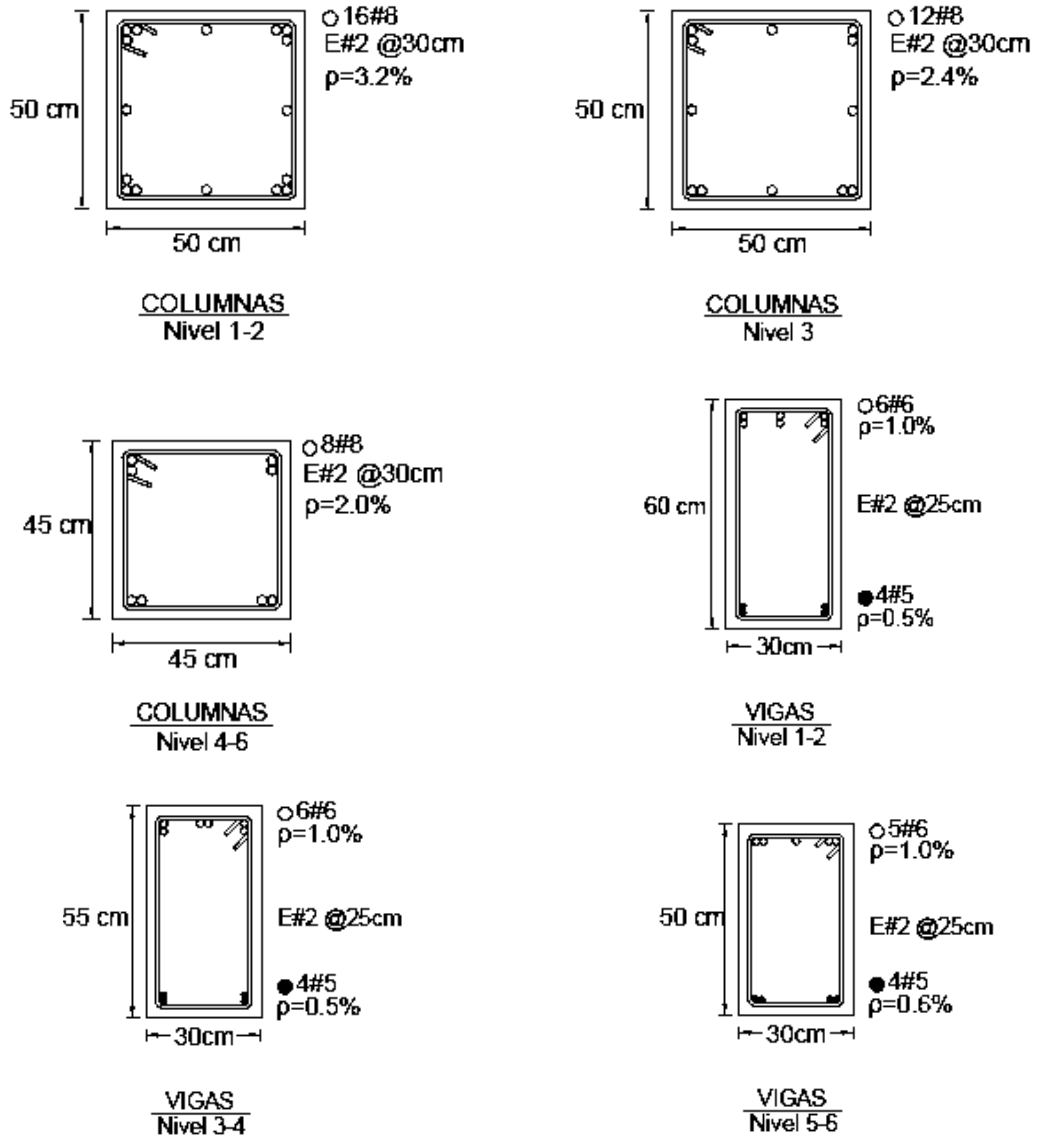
Armado de vigas y columnas del edificio de 6 niveles diseñado con las NTCS-76 con un Q igual a 6
